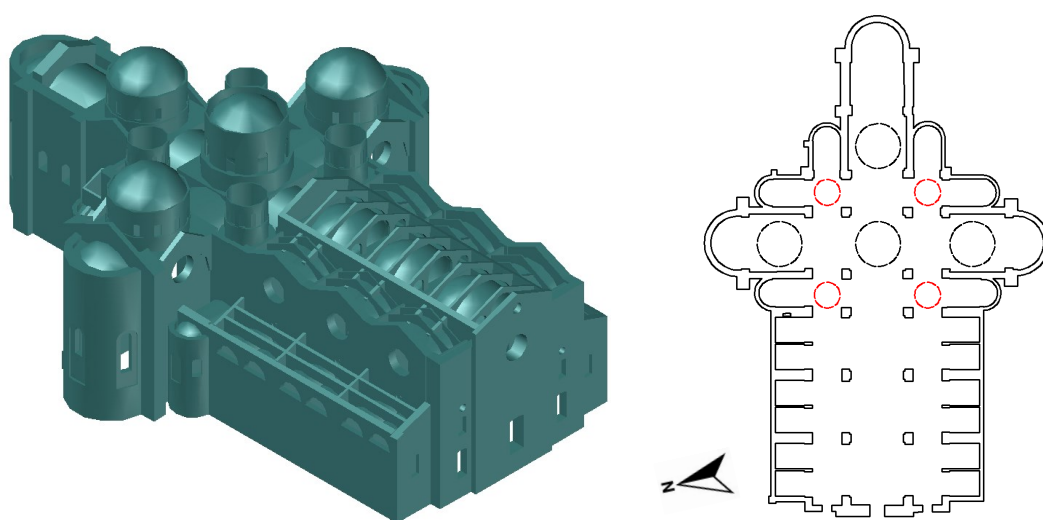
Vista assonometrica e pianta della fase 7 della struttura.
